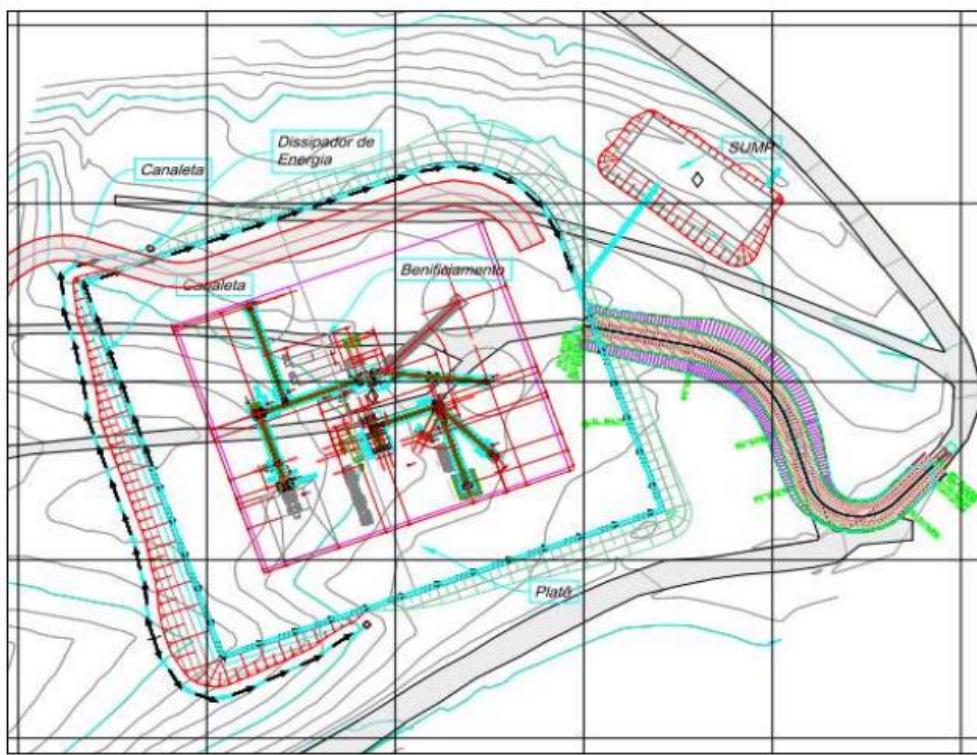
Estruturas de drenagem da planta de beneficiamento móvel e Tecnosolo. Fonte:
